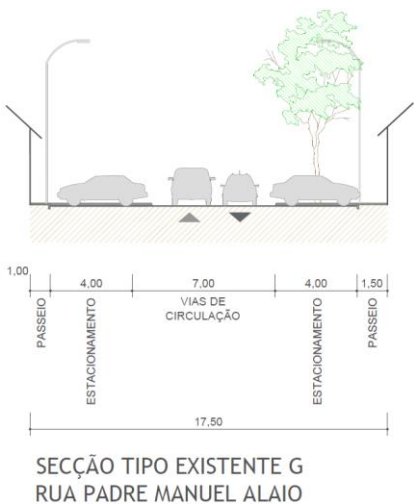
Secção tipo existente G - Rua Padre Manuel Alaio
